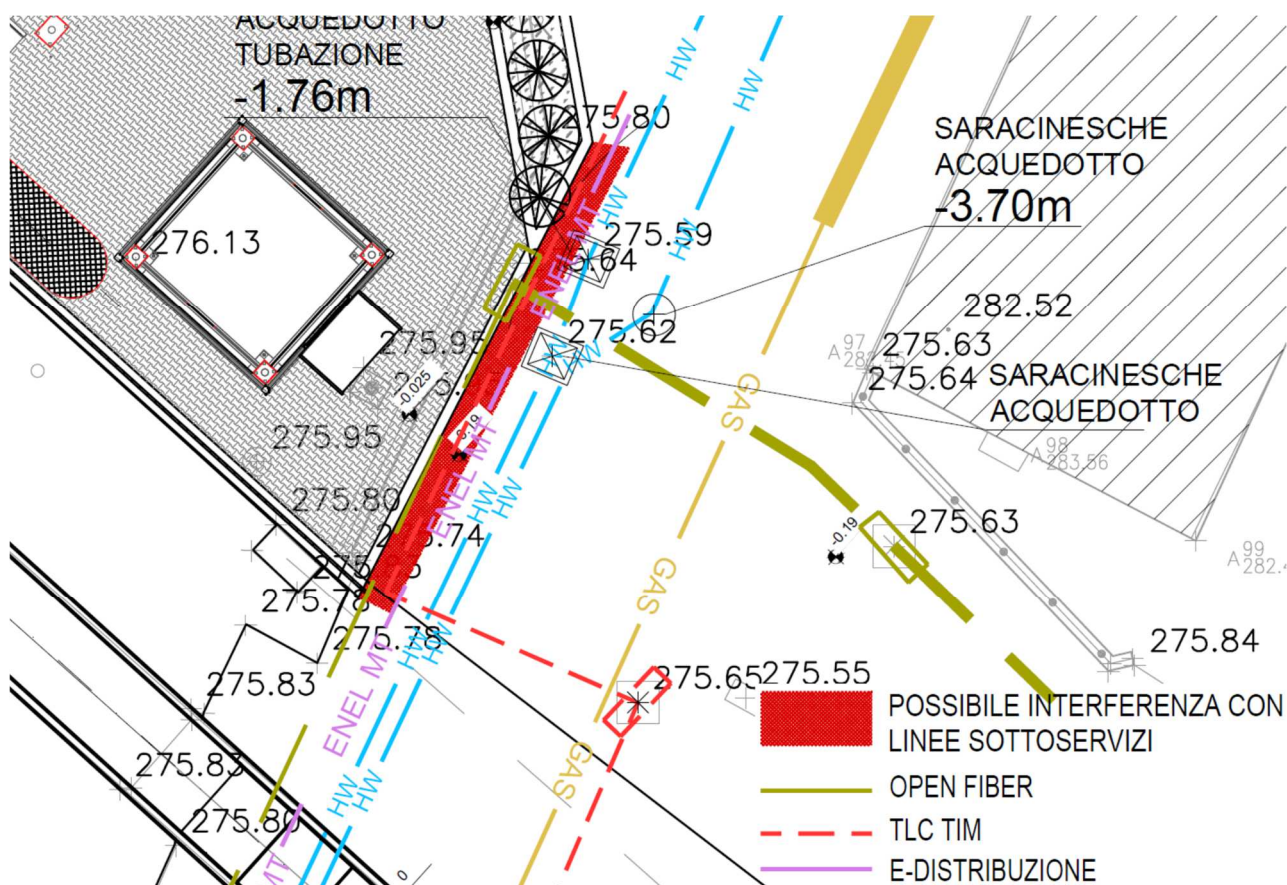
Estratto planimetria F30Dh001SR--R0 con evidenza della zona di possibile interferenza (lato via Cavour)
